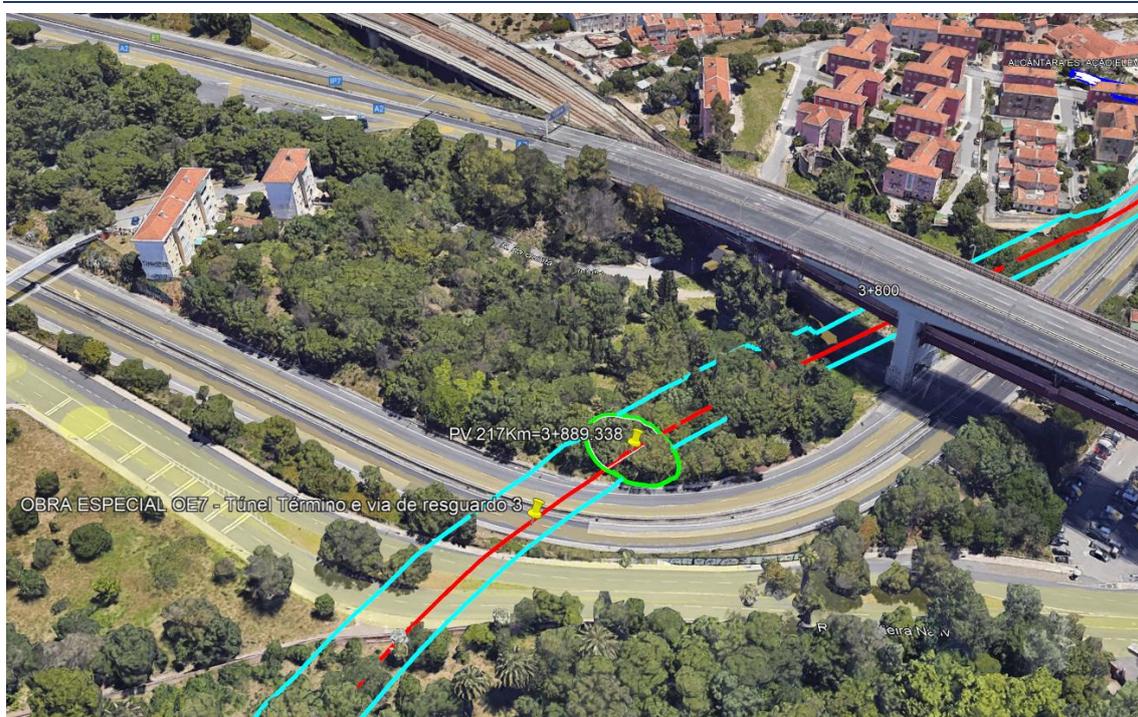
Poço de Ventilação PV217 (Km 3+889.338) e passagem do túnel junto à fundação do pilar do viaduto de acesso à Ponte 25 de Abril. – Implantação em Google Earth.
